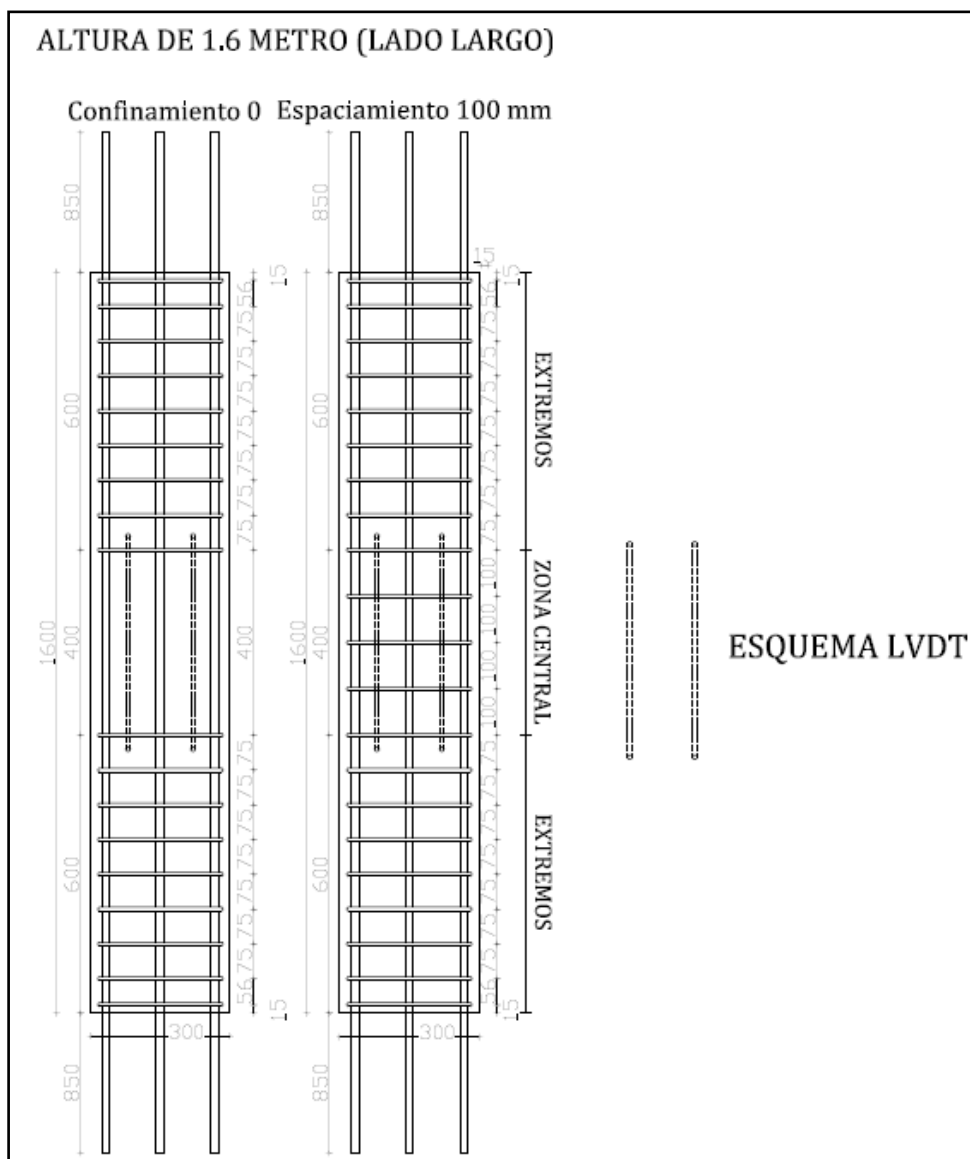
Distribución armadura transversal probetas con pre tracción de 1.6 m (barras pasadas)
